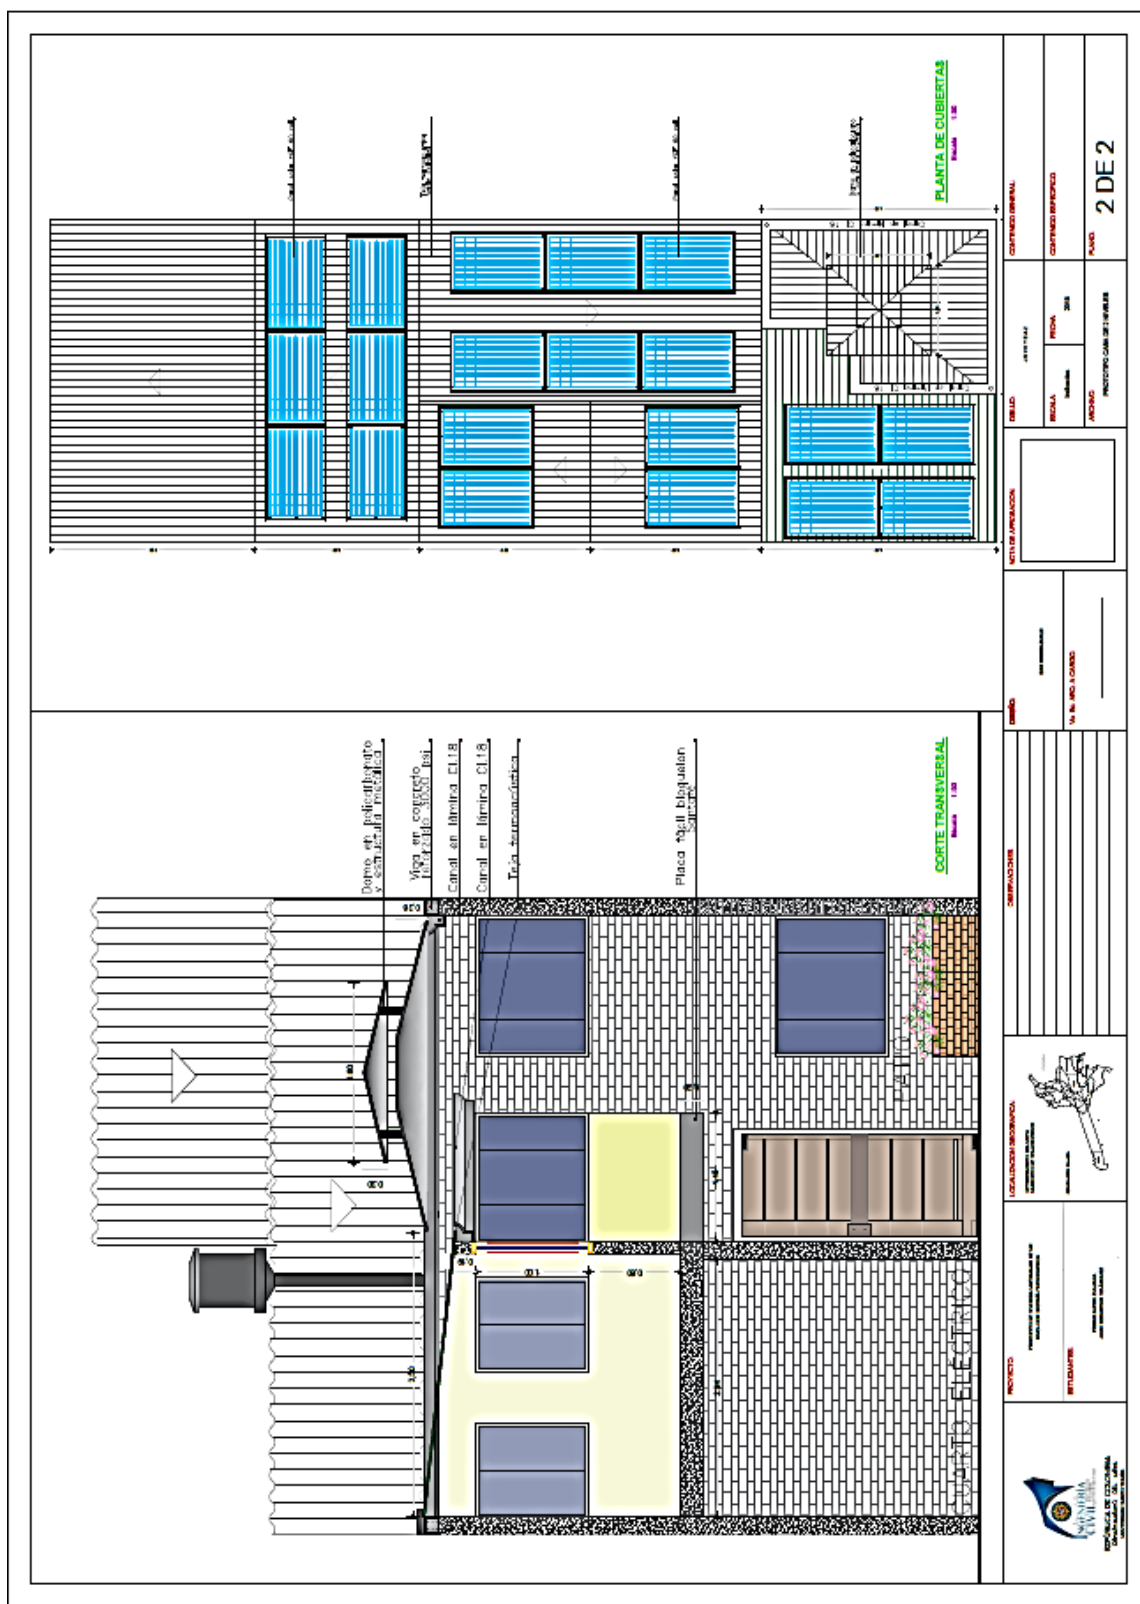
Planta de cubiertas vivienda de dos niveles. Fuente: Elaboración propia.
